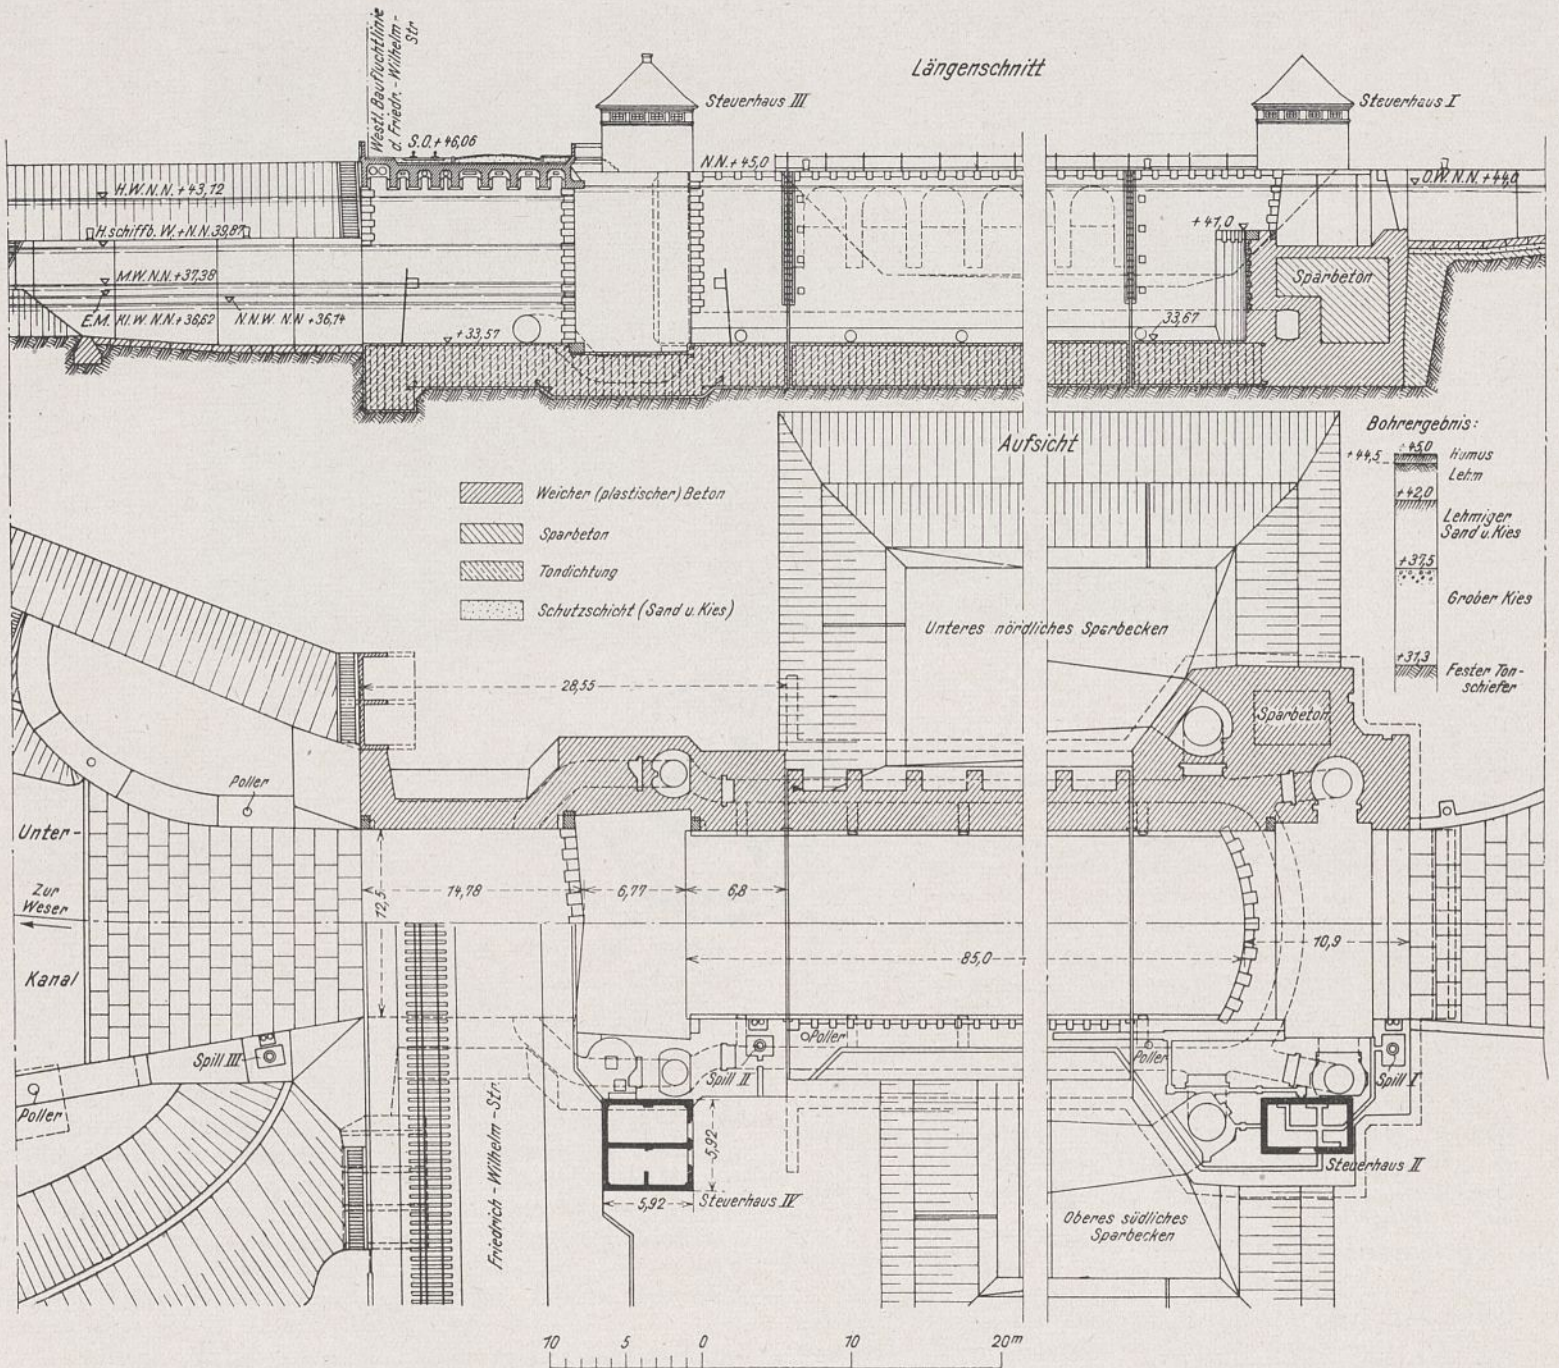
Unterschleuse, Längenschnitt und Grundriß.
